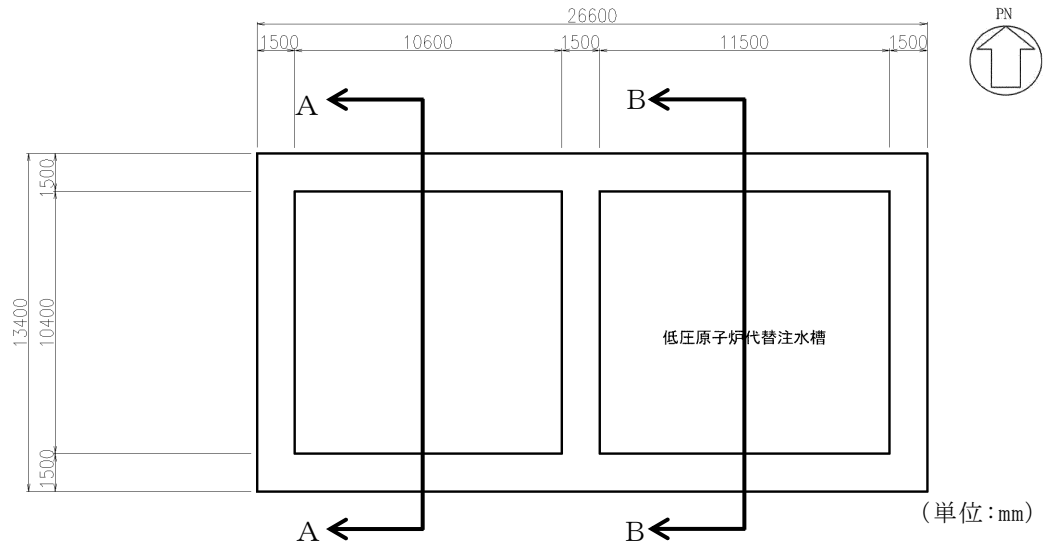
低圧原子炉代替注水ポンプ格納槽 評価対象断面位置図
